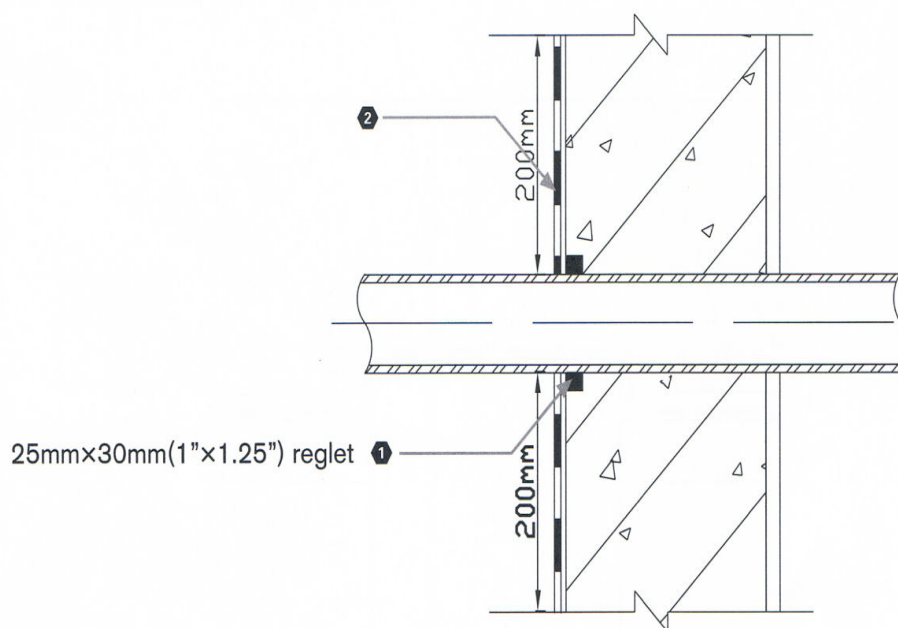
Esquema de aplicação de atravessamento de tubagens em paredes
